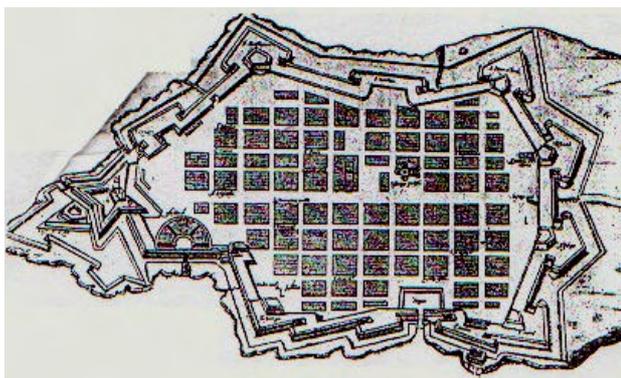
Planta da proposta de fortificação de La Valetta - Malta
